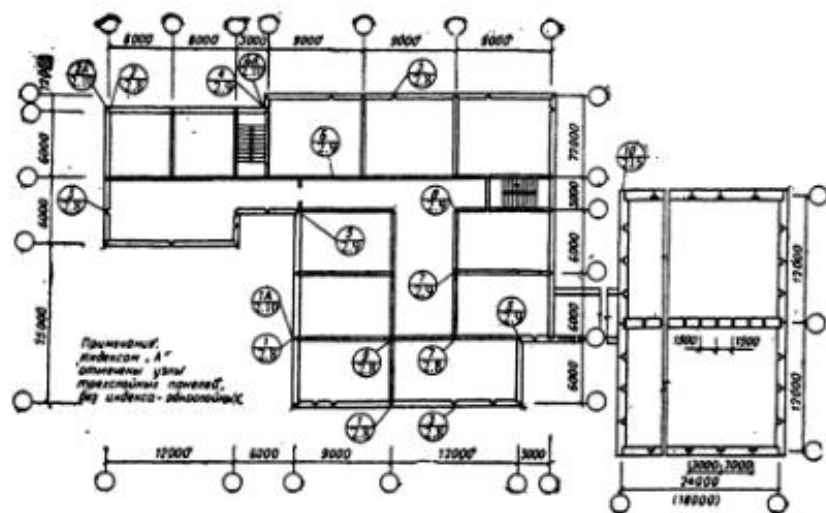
Схемы монтажного плана панелей наружных и внутренних стен с маркировкой узлов
